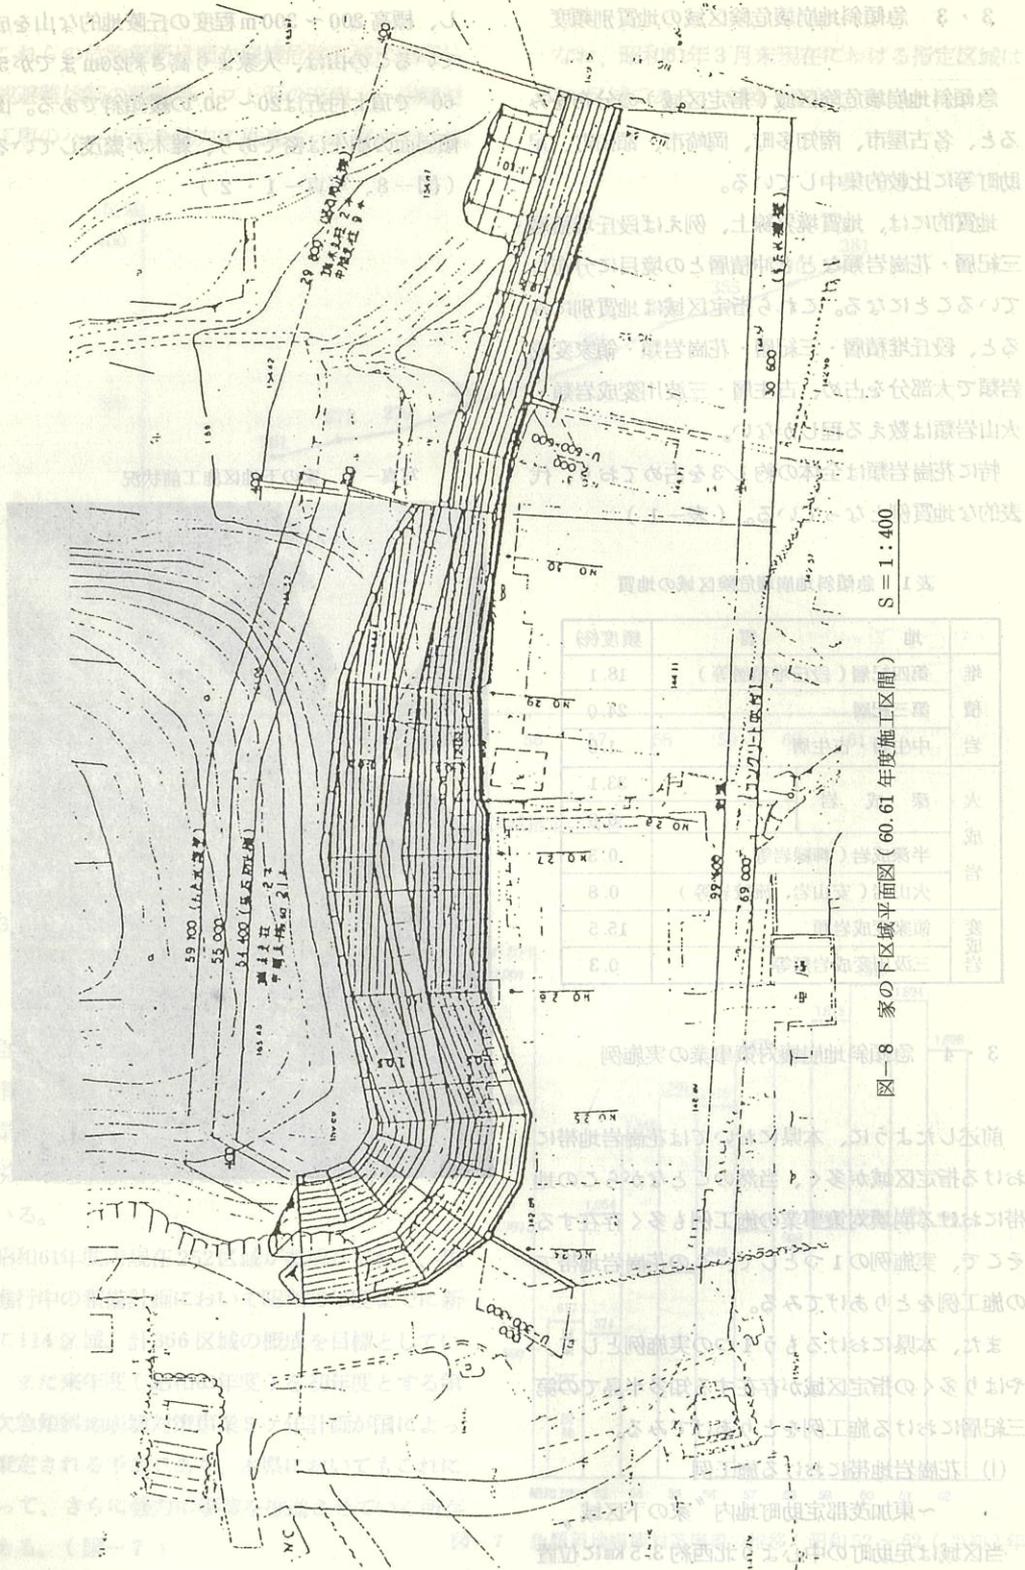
家の下区域平面図(60.61年度施工区間) S=1:400
